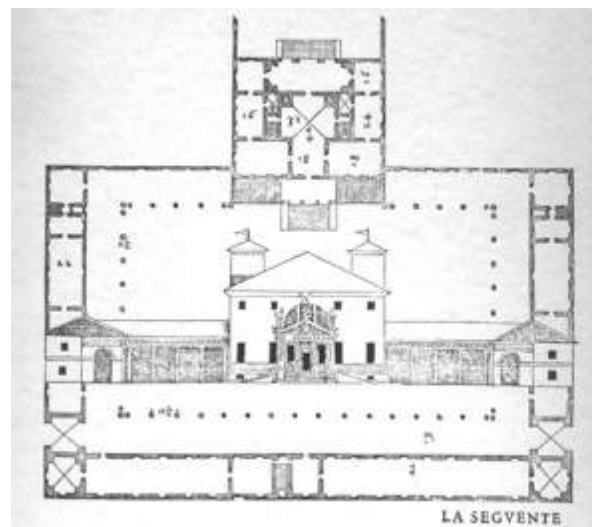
Planta y fachada de la villa Pisani, según aparece en página 47 de la primera edición del libro de Palladio, publicada en Venecia en 1570.
